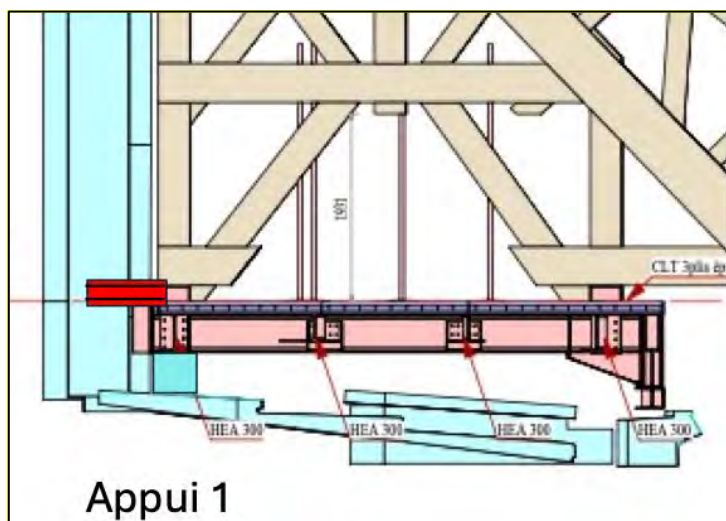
Schéma de principe des poutres d'ancrages du cintre aux murs de la cathédrale pour éviter le soulèvement
